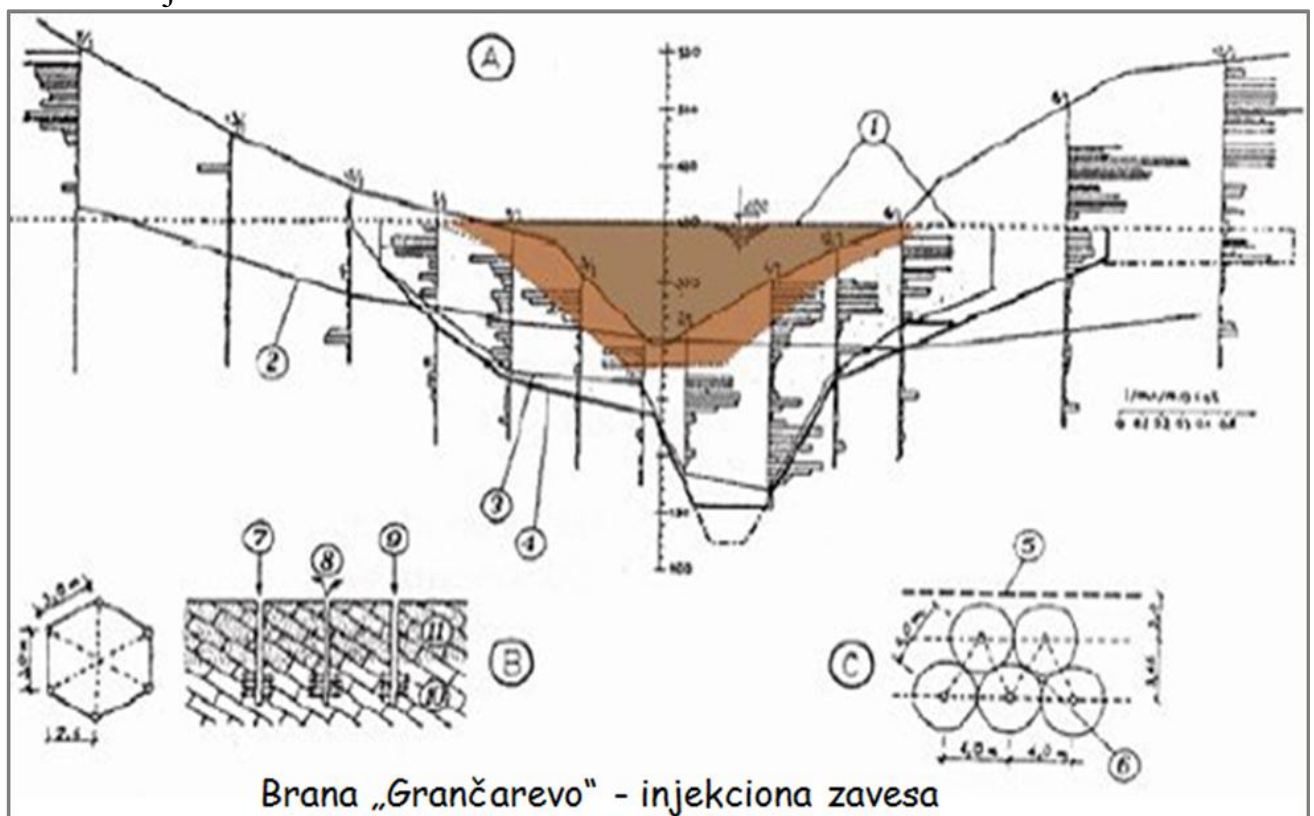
Smanjenje uzgona dreniranjem iza injektione zavesa
